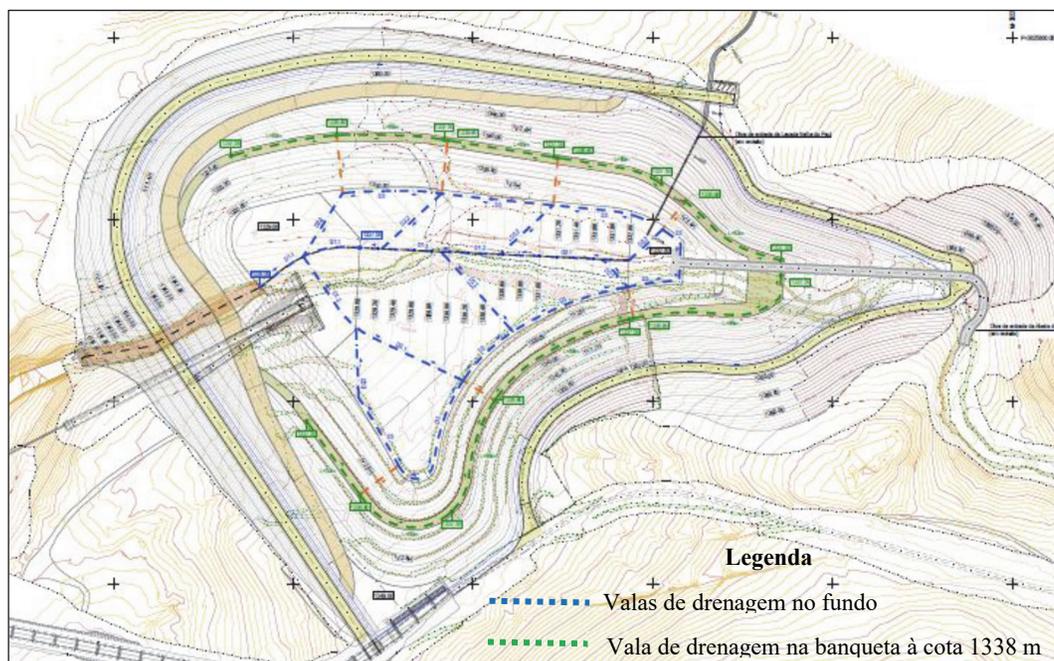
Planta com o sistema de drenagem subsuperficial da BPU (adaptado de TPF, 2019).
